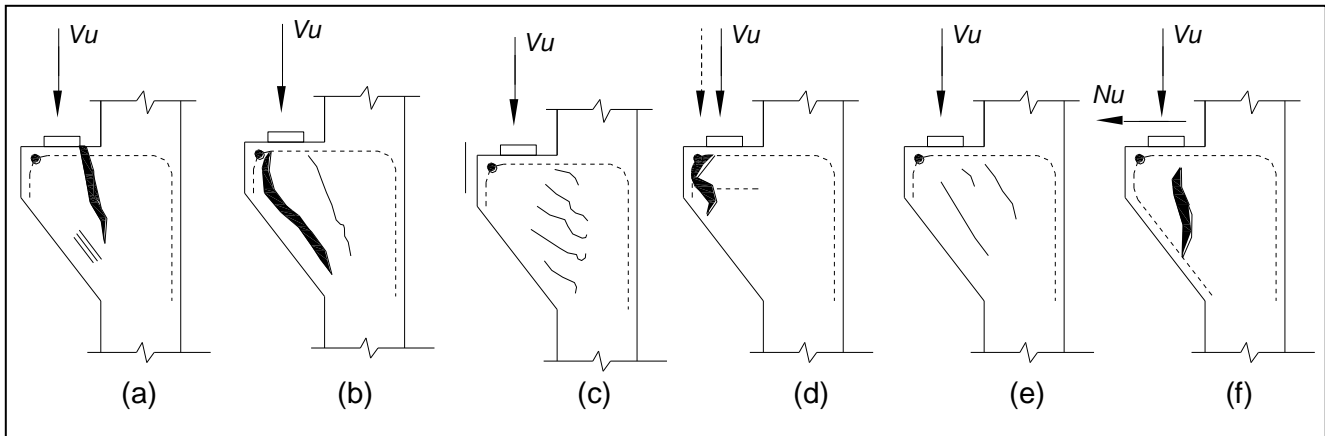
Mecanismos de falla en las ménsulas. (a) Tensión por flexión. (b) Fisuración diagonal. (c) Cortante deslizando. (d) Fisuración de anclaje. (e) Aplastamiento debido a esfuerzos de apoyo. (f) Tensión horizontal.
